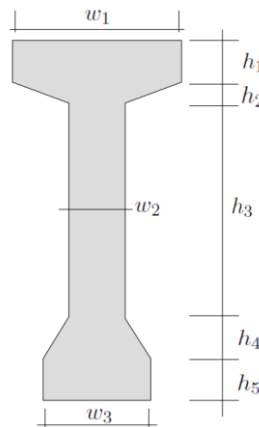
Seção transversal da viga de concreto pré-moldado
